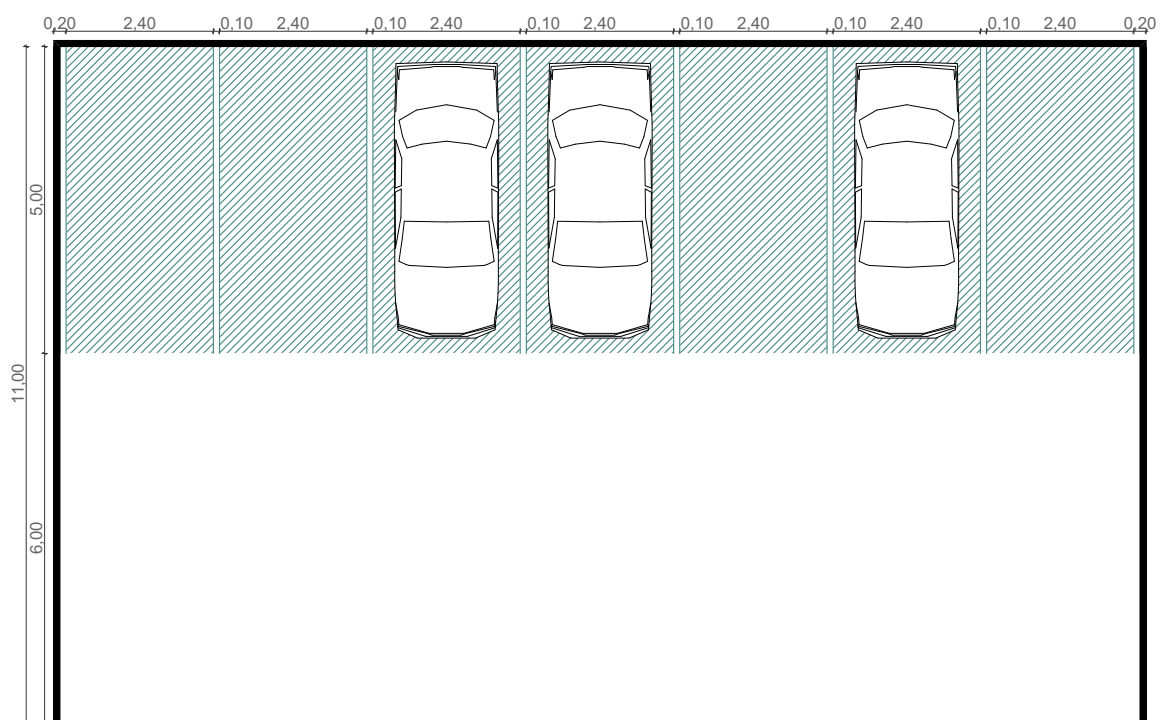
Planta de estacionamientos. Elaborado: Autores
